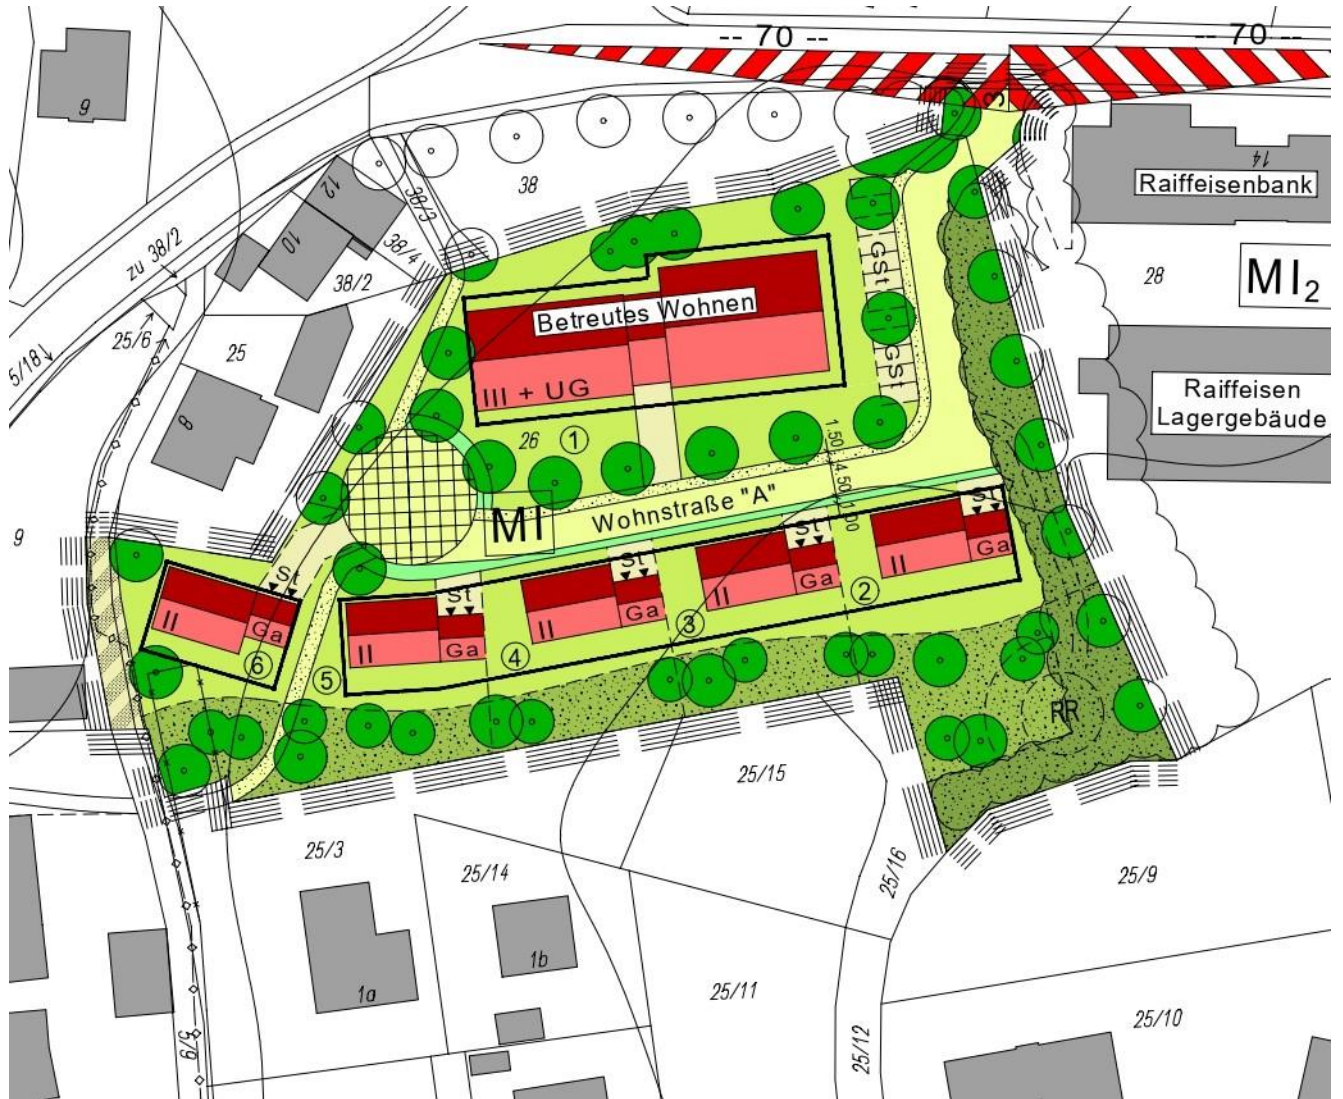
Plandarstellung der Überschneidungsflächen MU Tiefenbach und MI Weiherfeld – Ohne Masstab
